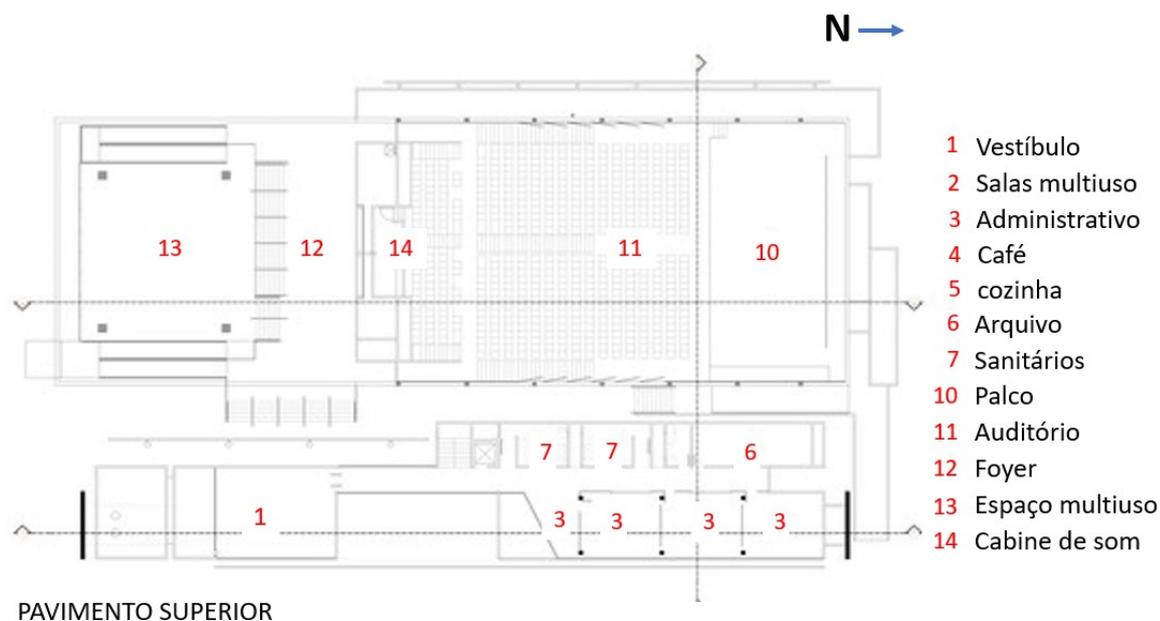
Planta baixa do pavimento superior. Fonte: Adaptado do Archdaily, 2018.
